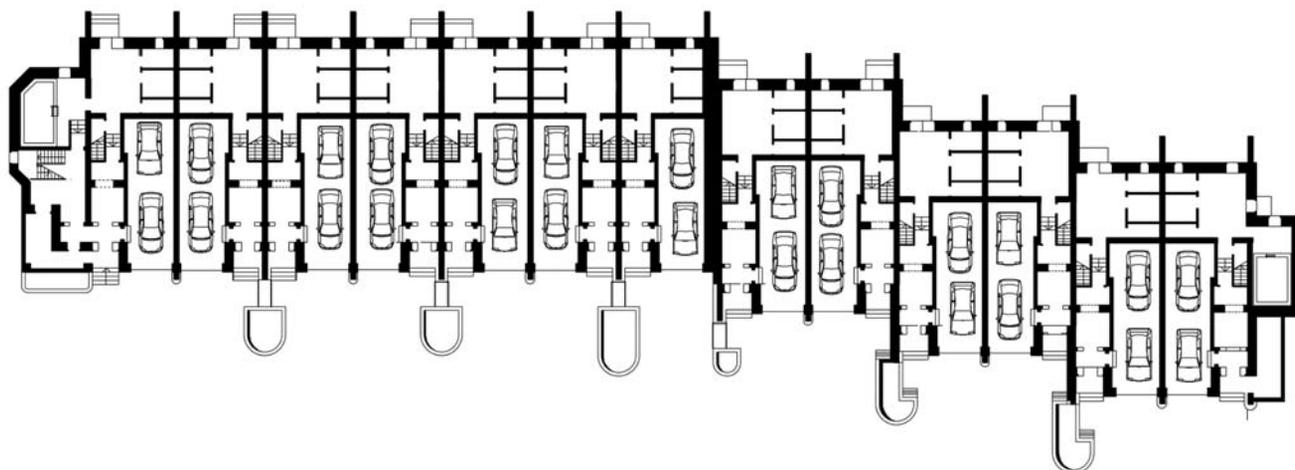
План первого этажа с попарно смещенными блок-квартирами
